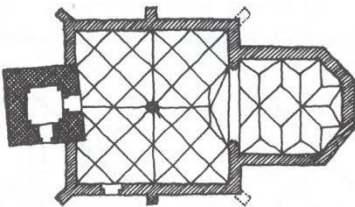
Schleiden, ehem Schlosskirche, Grundriss
